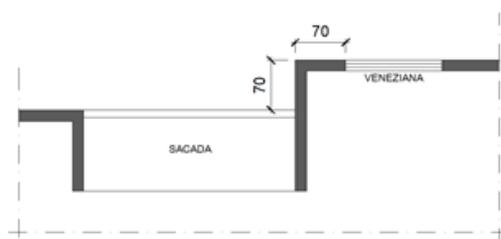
c – Distância entre a veneziana da escada EP e qualquer outro tipo de abertura em plano vertical paralelo.
